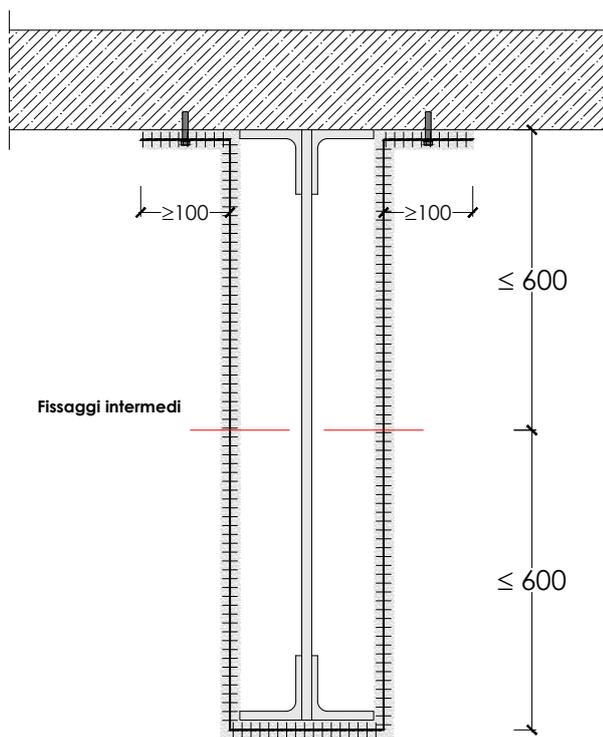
Schema di applicazione per protezione di trave reticolare in carpenteria metallica (applicazione a box)
